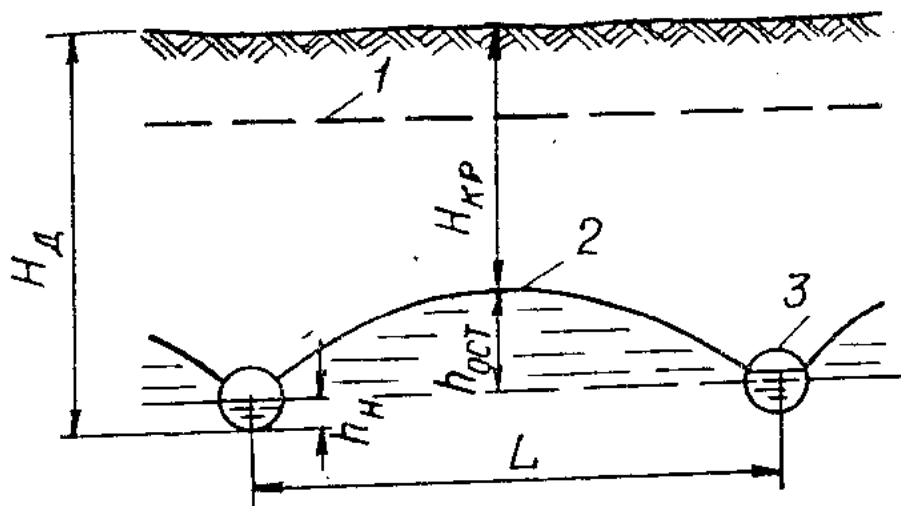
Схема понижения уровня грунтовых вод горизонтальным дренажом: 1, 2 - уровень грунтовых вод соответственно до и после строительства дренажа; 3 - горизонтальные дренажи; H_d - глубина заложения дренажа; $H_{кр}$ - критическая глубина залегания грунтовых вод; $h_{ост}$ - остаточная глубина залегания грунтовых вод; h_n - глубина наполнения дрены
